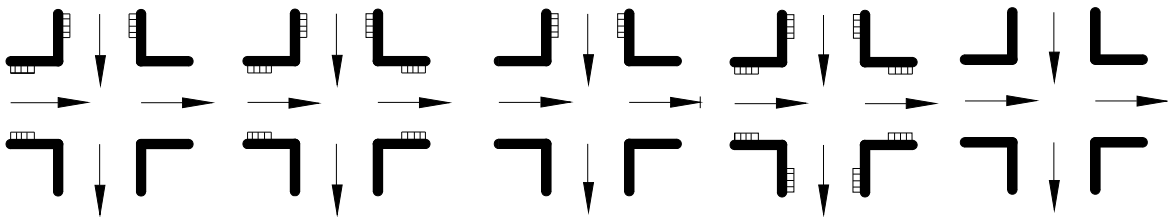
Схемы расположения дождеприемников на перекрестке улиц
